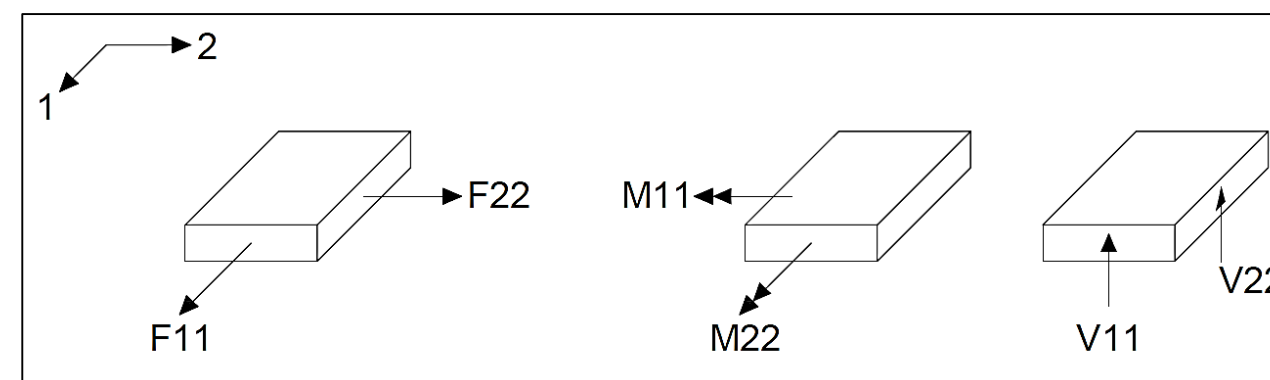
Criterio de signos de SAP2000 para los esfuerzos de la losa. Elaboración propia con AutoCAD.
